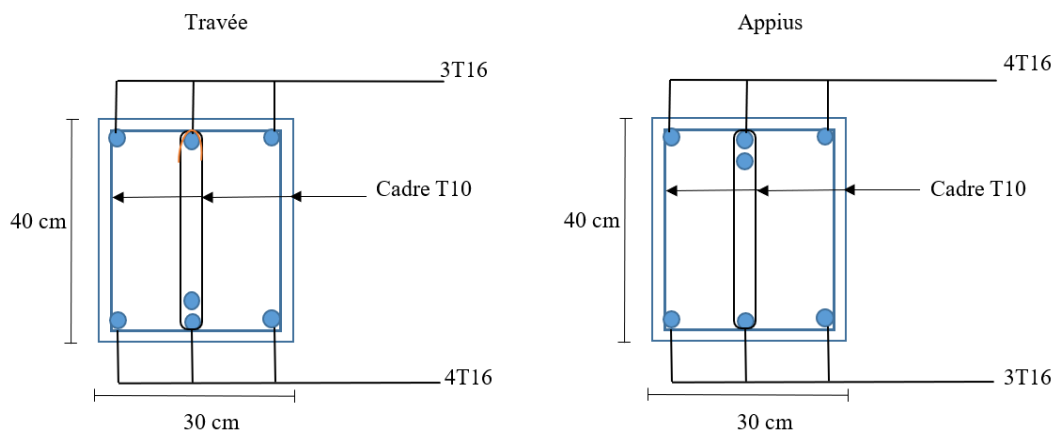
Ferrailage de la poutre secondaire du plancher terrasse avec voile.
